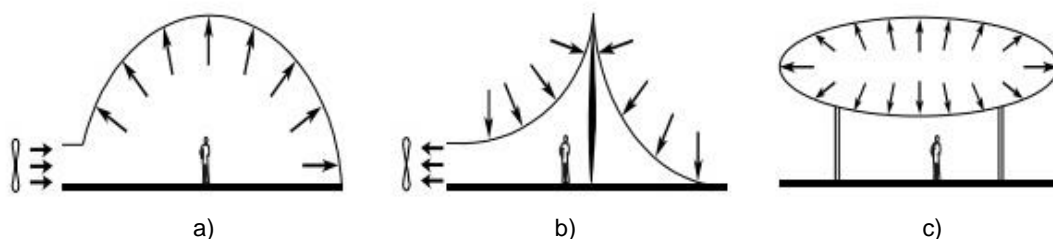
Estruturas Pneumáticas: a) Insuflada; b) Aspirada; c) Infladas
